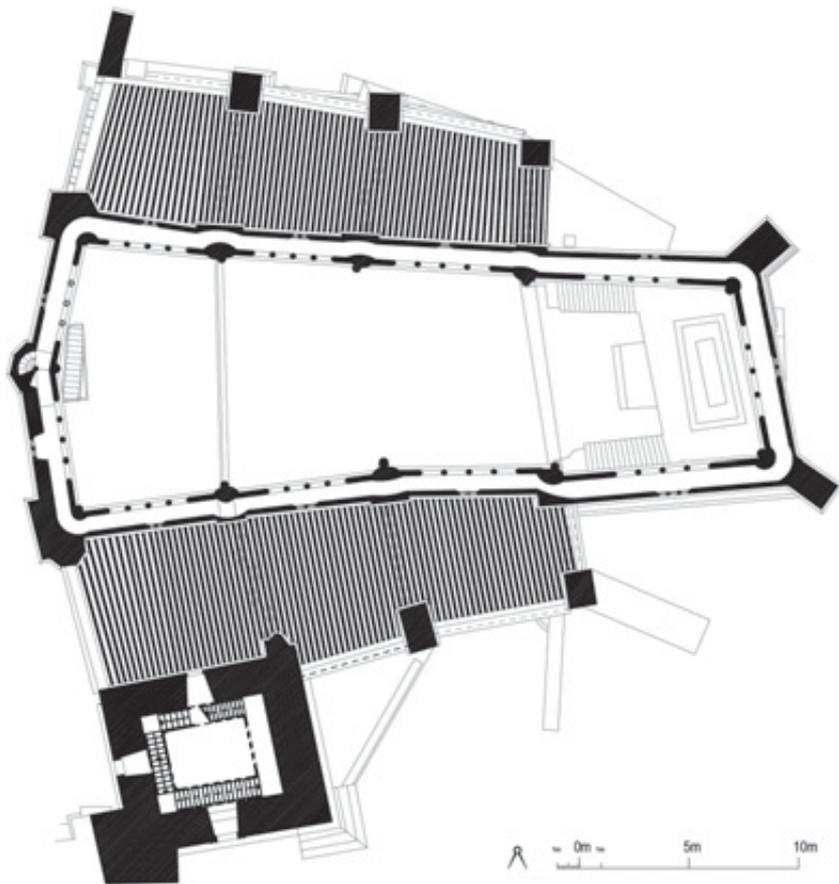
San Salvador de Getaria: Planta al nivel del claristorio. Dada la extrema esbeltez de los muros, las paredes apenas incorporan material resistente, excepto en la mitad meridional de la fachada occidental, rehecha por los prudentes cuidados de Tiburcio Spanochi.
